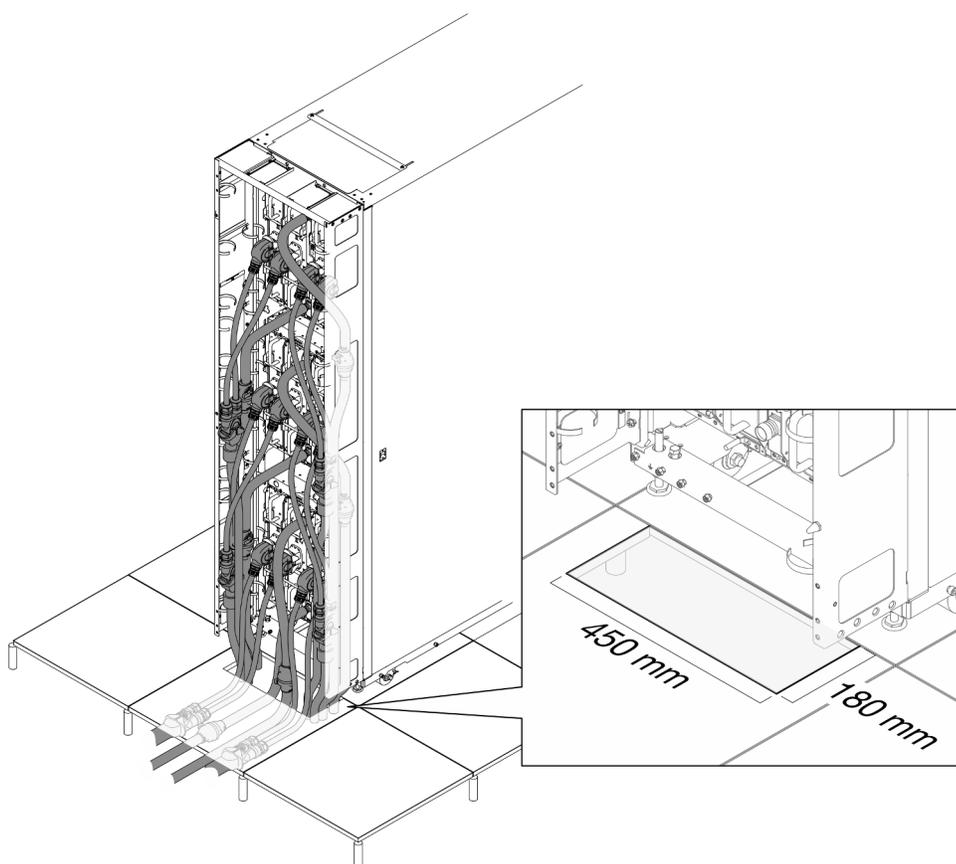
Recommandation de découpe au sol pour le cheminement des câbles sous plancher
